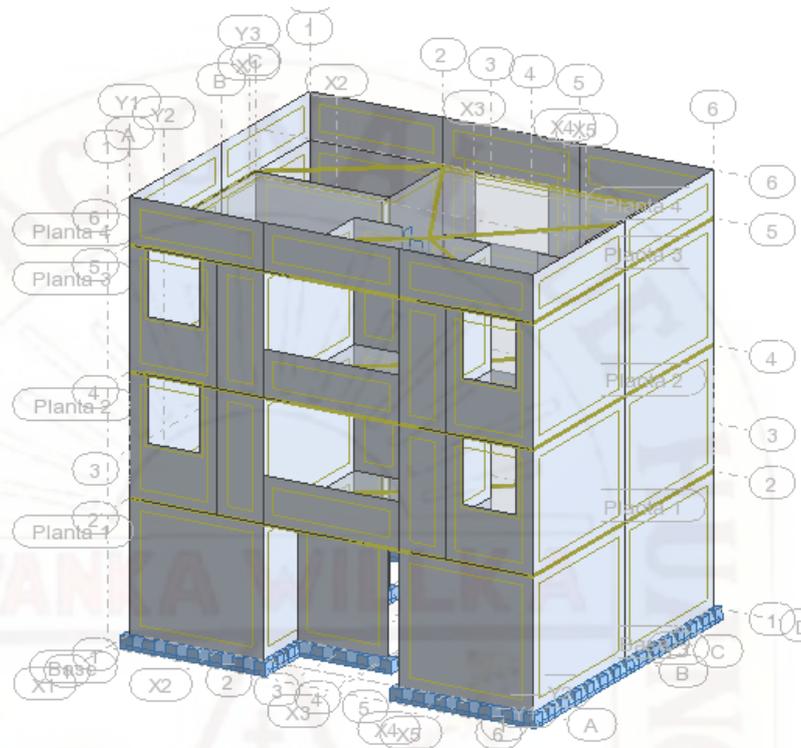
Modelo tridimensional de la edificación mediante el sistema estructural Emedos (M-2)
